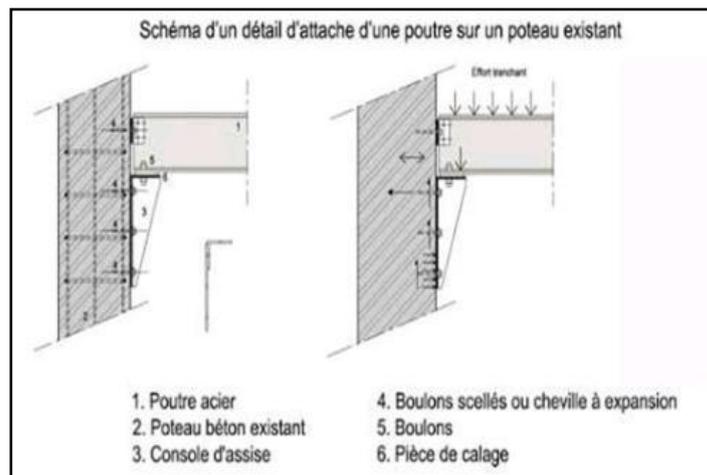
détail d'assemblage poteau Béton armé / poutre métallique
